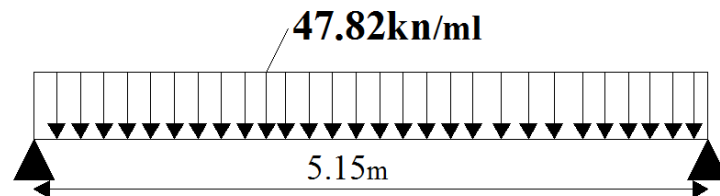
schéma présentatif de la poutre palier au L'ELU
